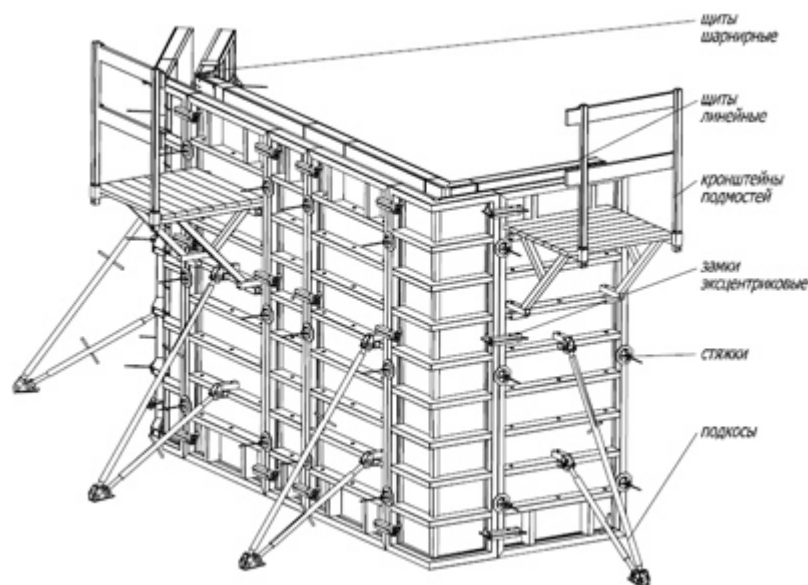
Фрагмент установки великощитовой опалубки для бетонирования стен
